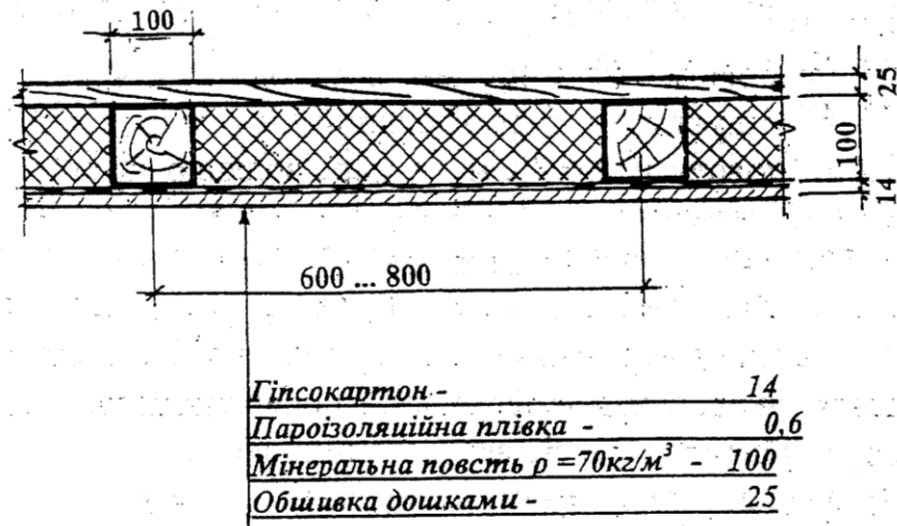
Утеплена каркасна стіна між приміщеннями мансарди і горища (план)
